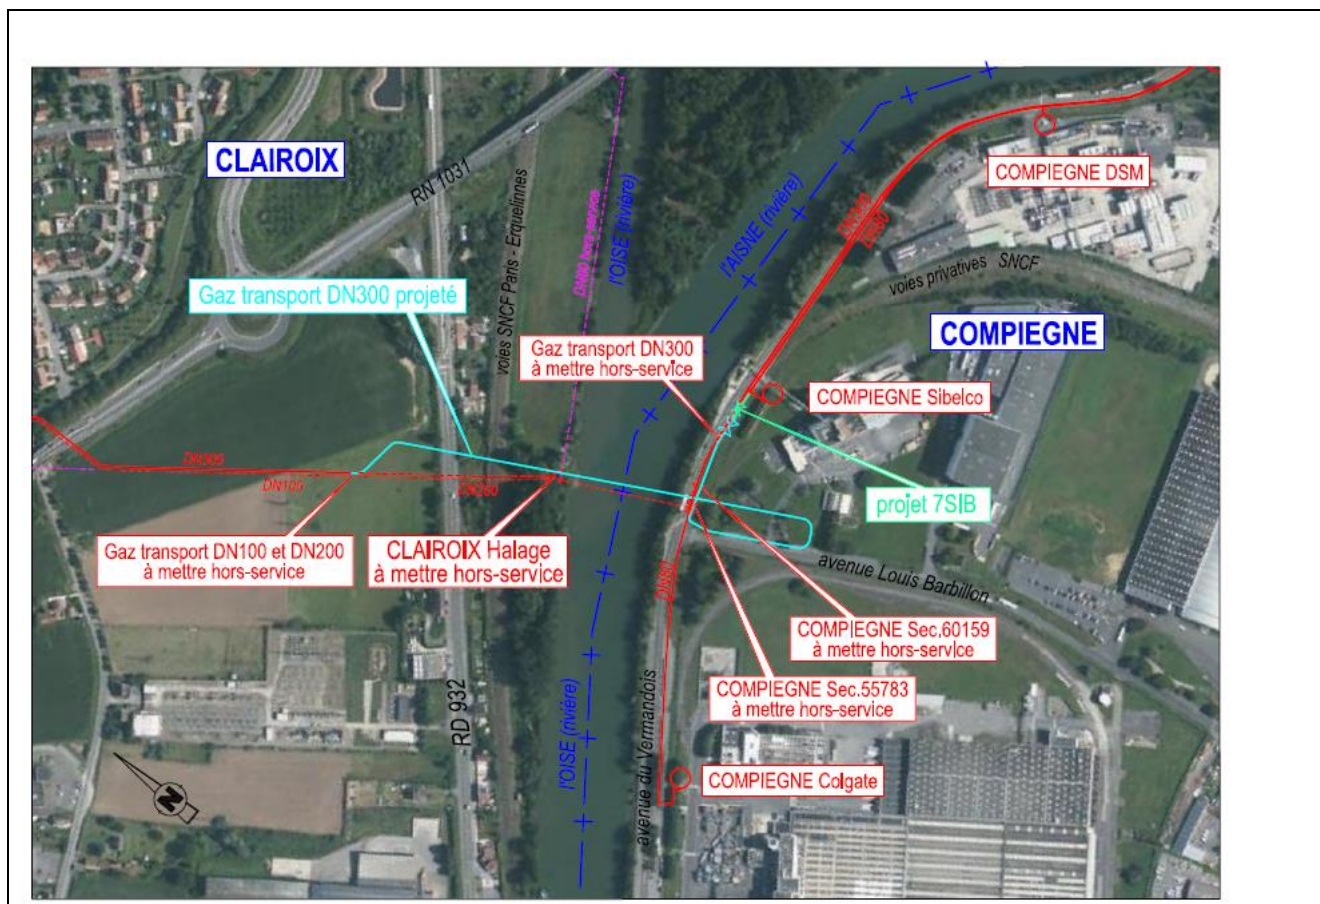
Plan 1/ 25 000 de situation de l'ouvrage projeté
